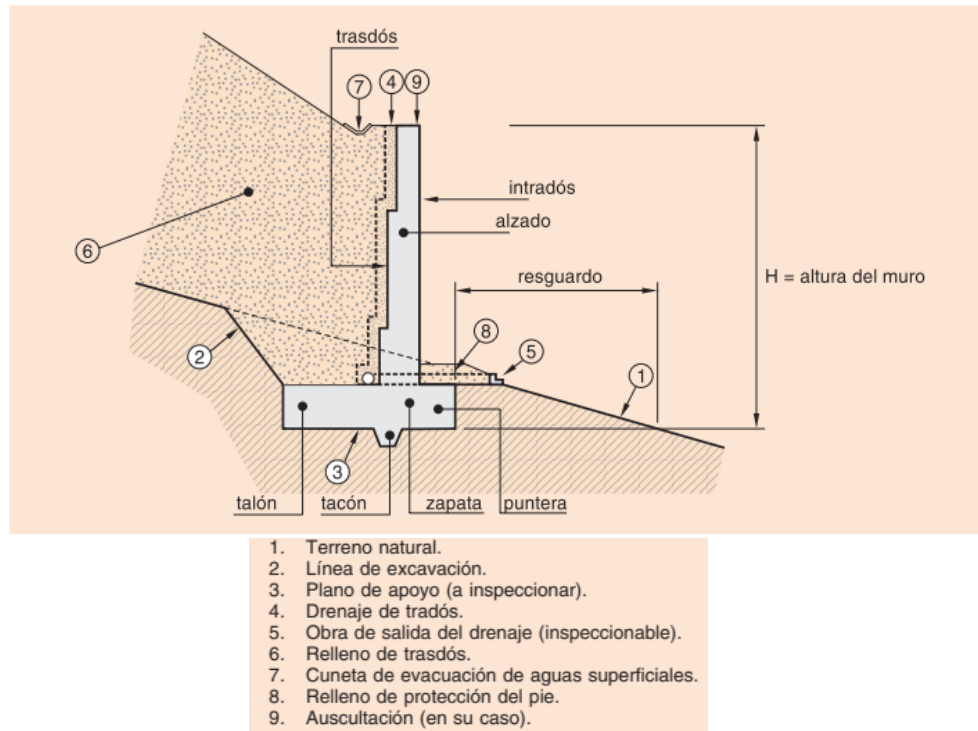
Esquema de un muro de en voladizo (Fuente: Guía de cimentaciones en obras de carretera (DGC, 2009))
